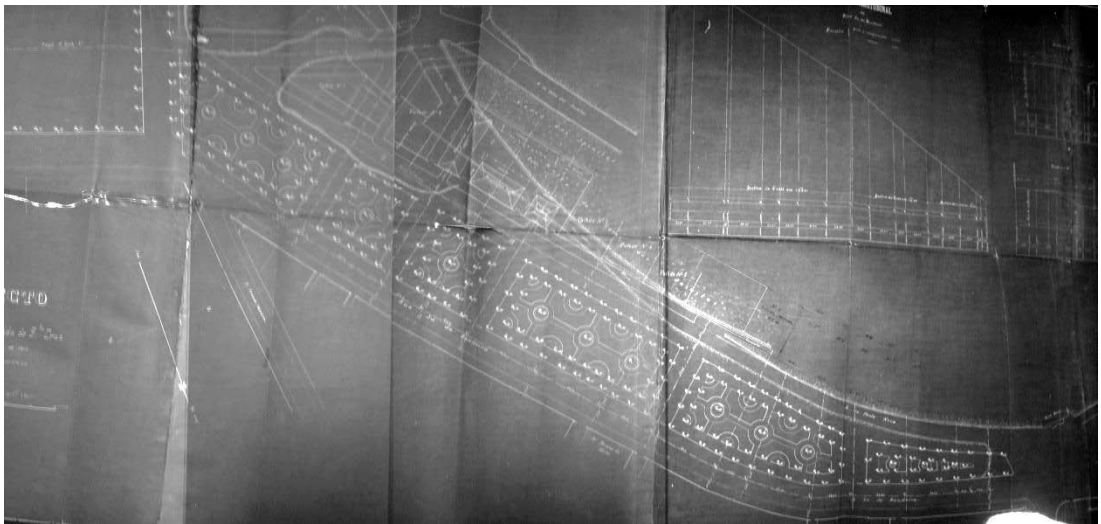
Extrato da Planta e Perfis dos desenhos de António Heitor “Projeto para a construção da Avenida de Santa Cruz”, 4 de maio de 1906 [*Diversos, Maço III* (Coimbra: AHMC/B15/3)]
